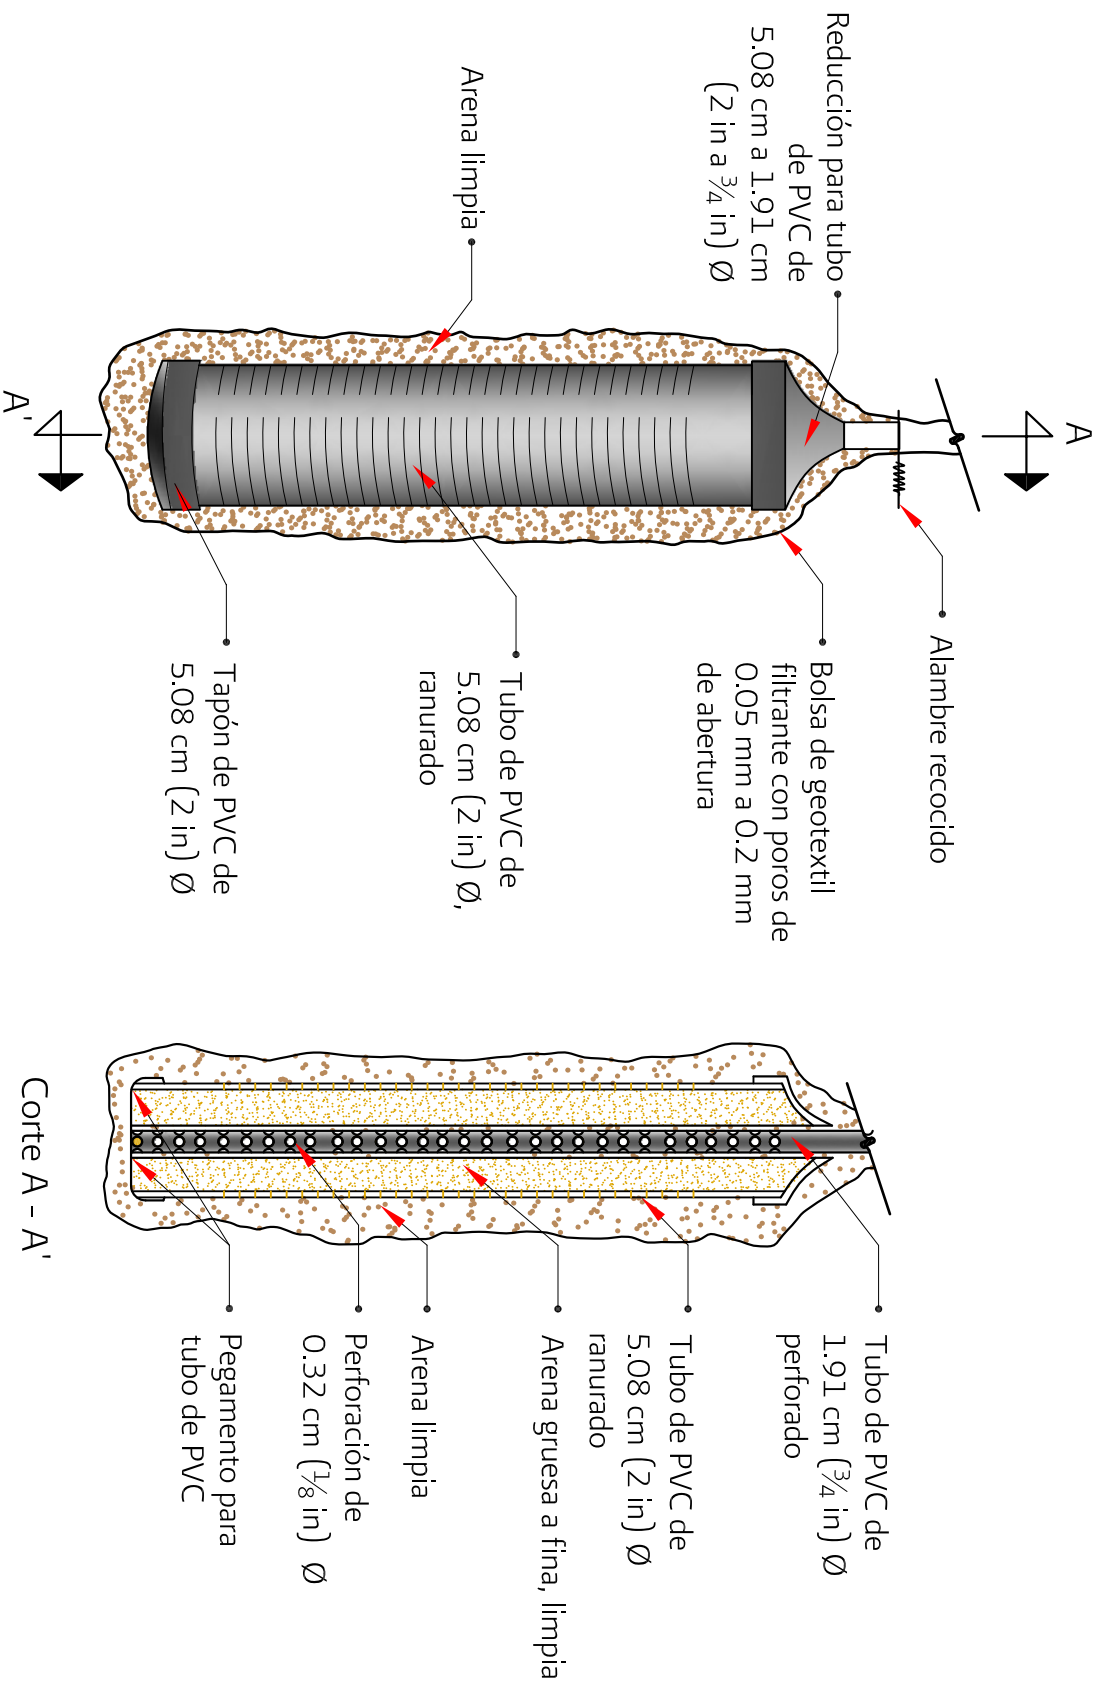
Bulbo del piezómetro abierto empacado en arena y bolsa de geotextil
